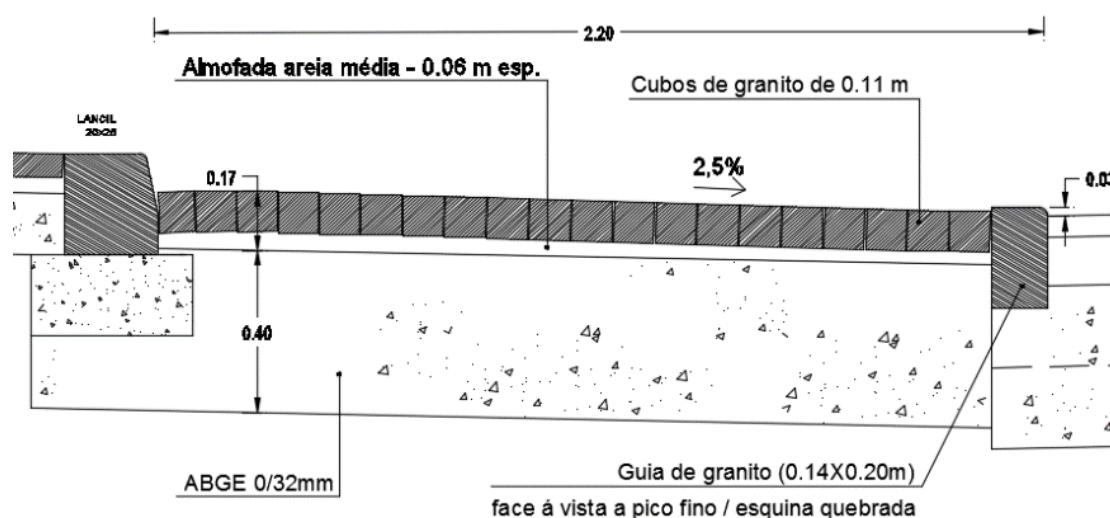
Pormenor de pavimentação de uma baia de estacionamento
